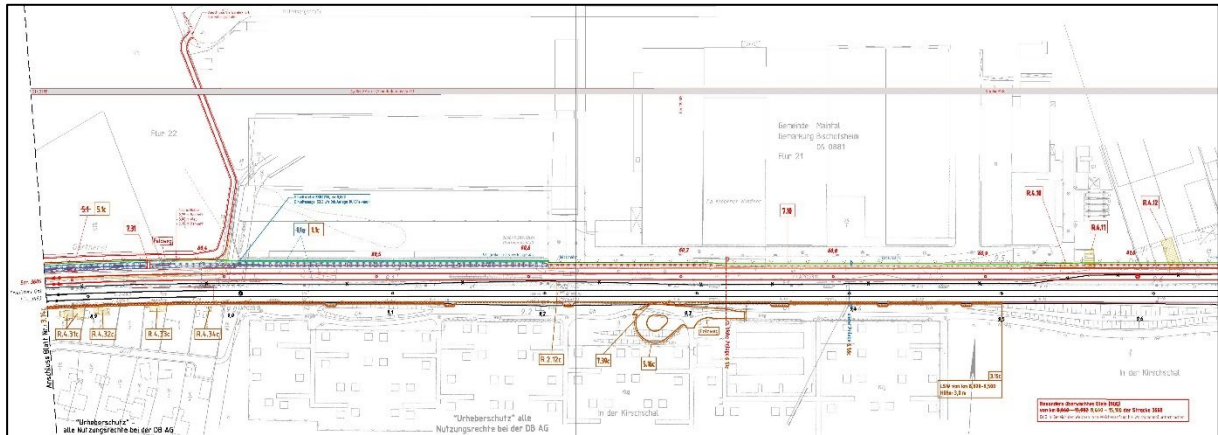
Lageplan S-Bahn Rhein-Main, Nordmainische S-Bahn, Planfeststellungsabschnitt 2 – Maintal *Quelle: DB Netz AG 2024
